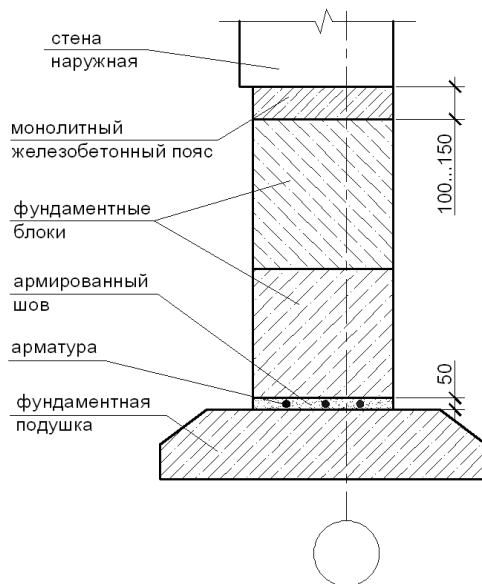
Узел фундамента на слабых и сильносжимаемых грунтах
